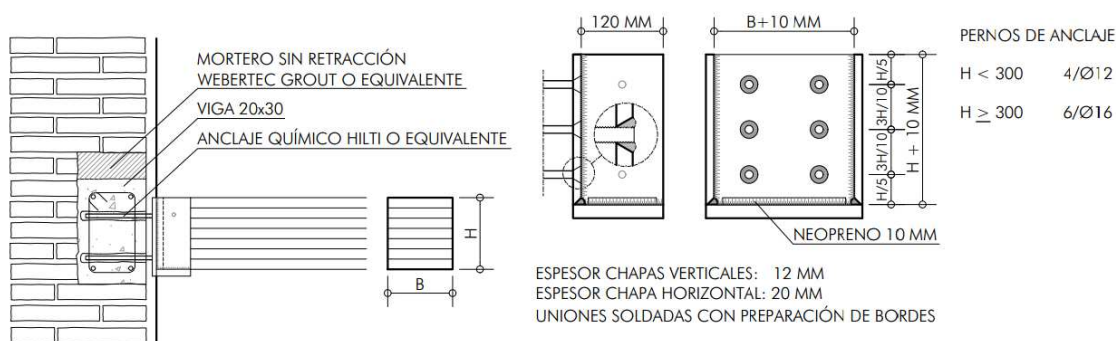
Apoyo de vigas de madera laminada encolada en muros
